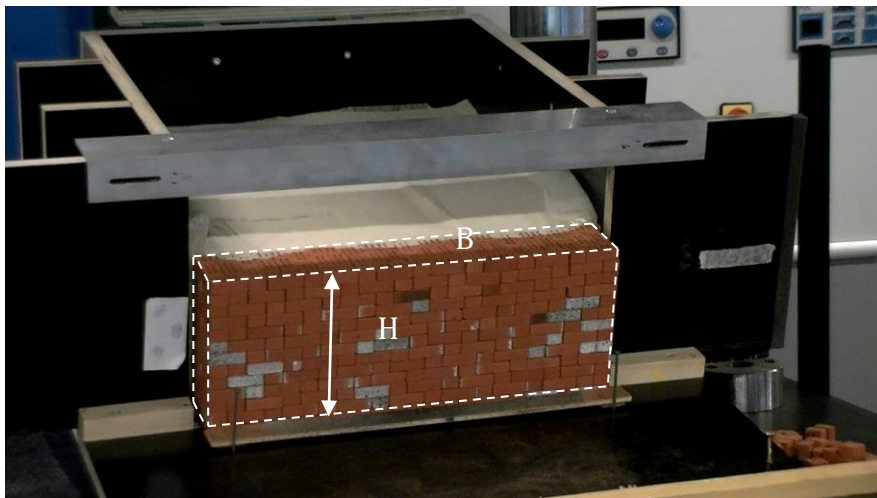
Maquette dans une position inclinée. Une presse est utilisée pour soulever l'arrière de la maquette. L'angle d'inclinaison de rupture dépend des dimensions géométriques (H et B) du mur.
